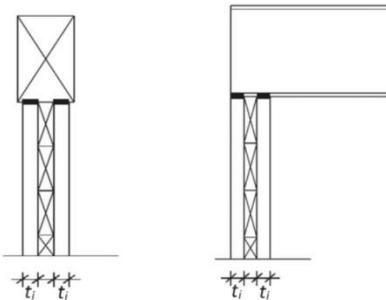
Appui de poutre sur mur en panneaux structuraux massifs bois - Largeur d'appui
